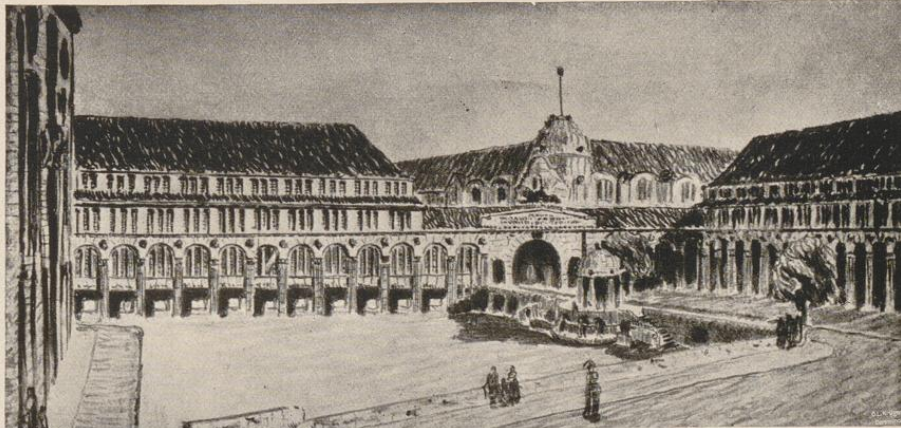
Schaubild zu obigem Lageplan von der Süd-West-Ecke des Warenhauses Althoff aus. Rechts Verkaufshalle zwecks einheitlicher Raumwirkung durch Ladenbauten mit der Sparkasse verbunden.
